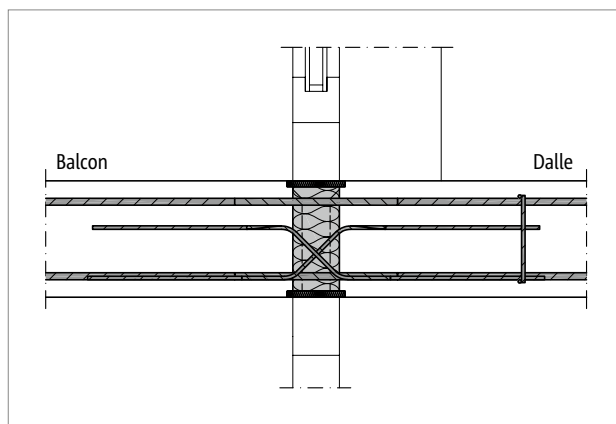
Schöck Isokorb® T Type D : Coupe de montage ; plancher à axe unique
